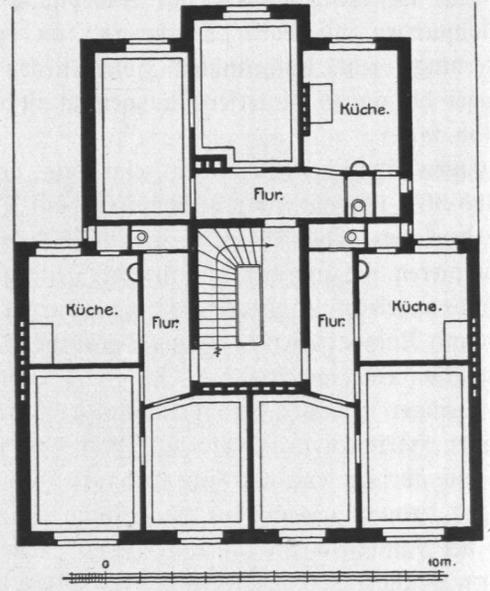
Haus Nieburstraße Nr. 32, Obergeschoß.
